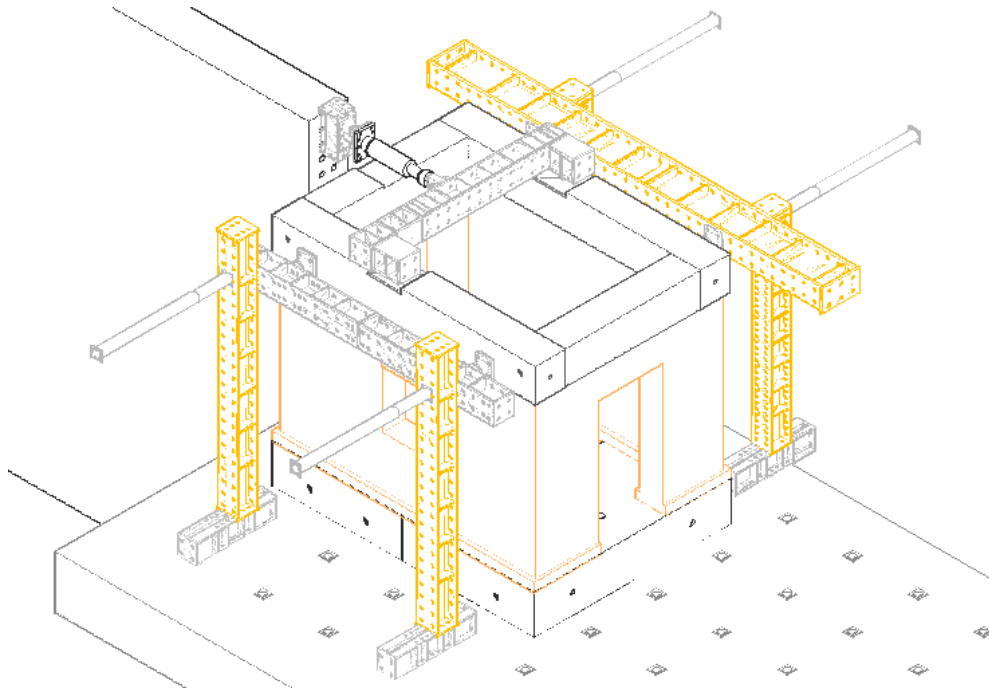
Projeto do modelo de adobe (Fachada Sul/Este)
